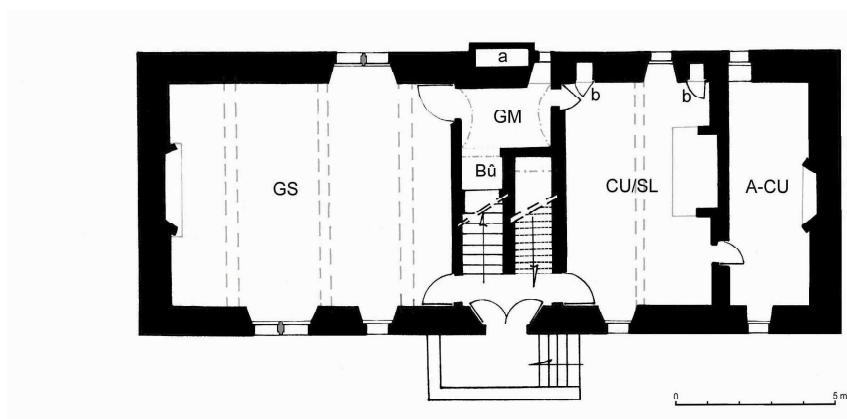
Longuelune. Plan restitué du rez-de-chaussée entre 1546 et 1550.
